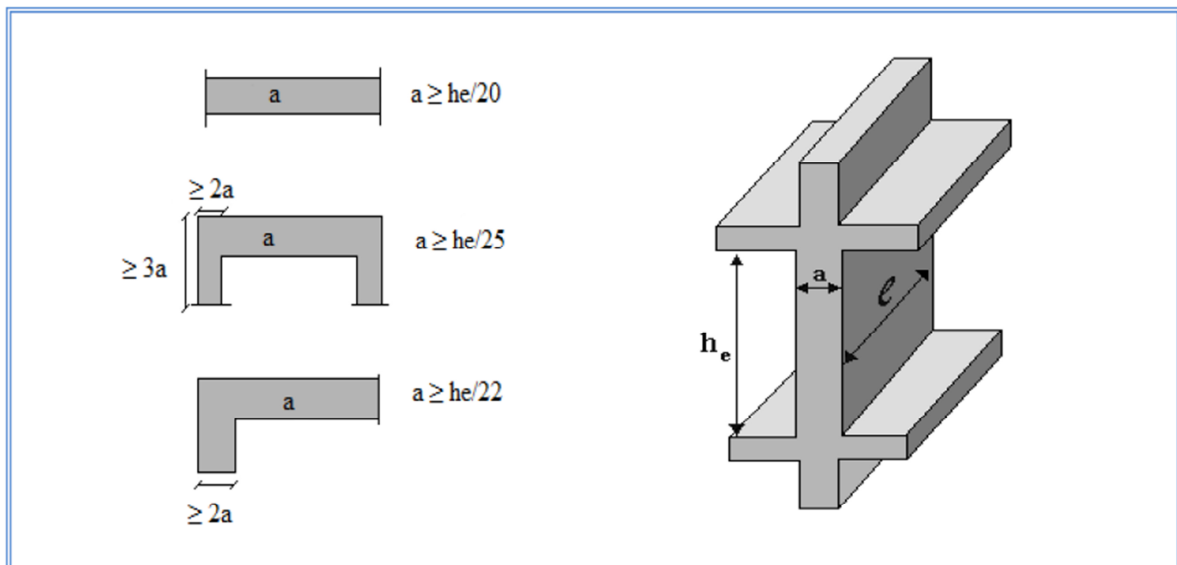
Coupe de voile en plan (gauche) Voile en 3D (droite).
